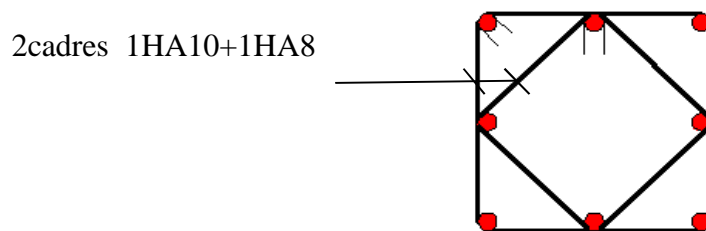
Armatures transversales des Poteaux des Niveaux 6 à 9
